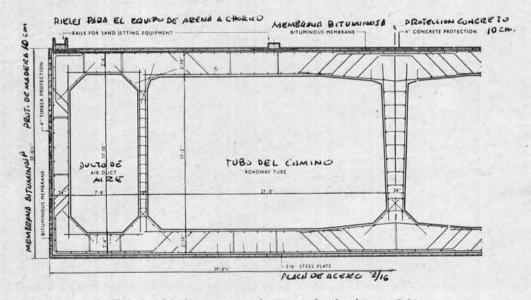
Sección transversal mostrando el refuerzo típico.
